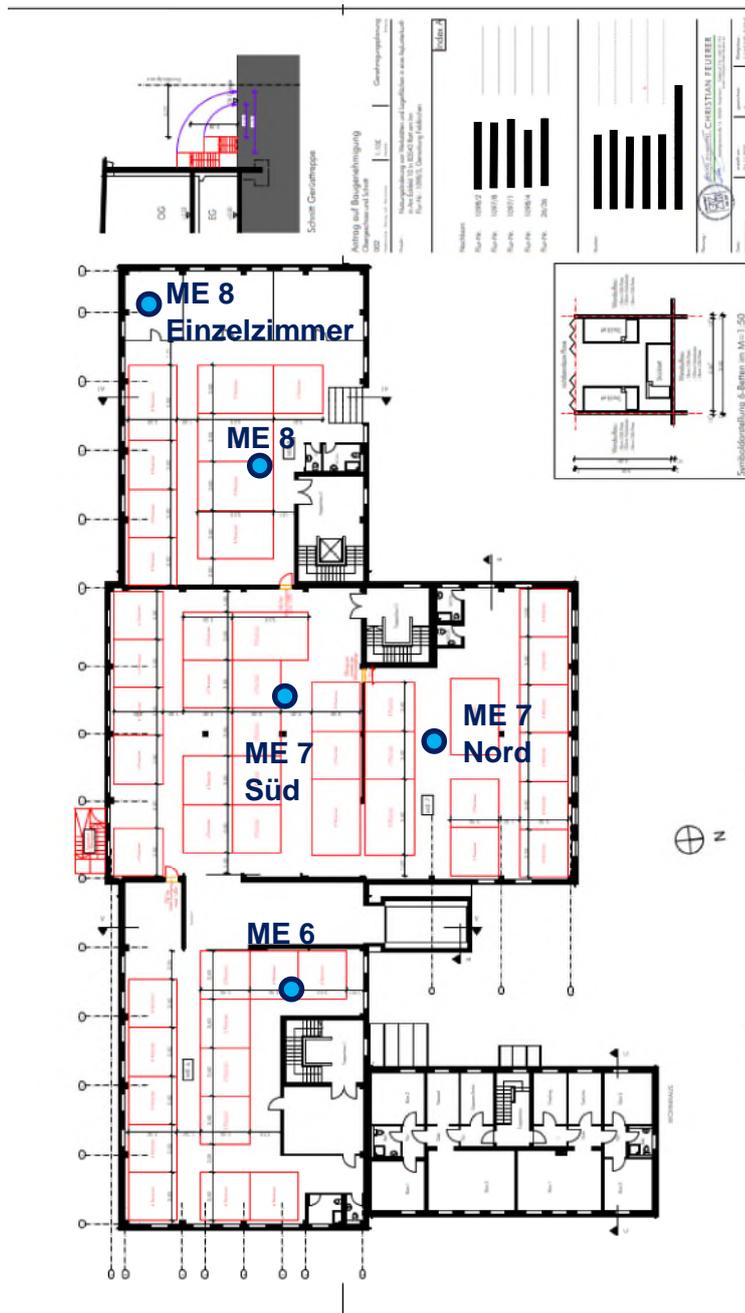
Lageplan Obergeschoss mit Probenahmestellen.
